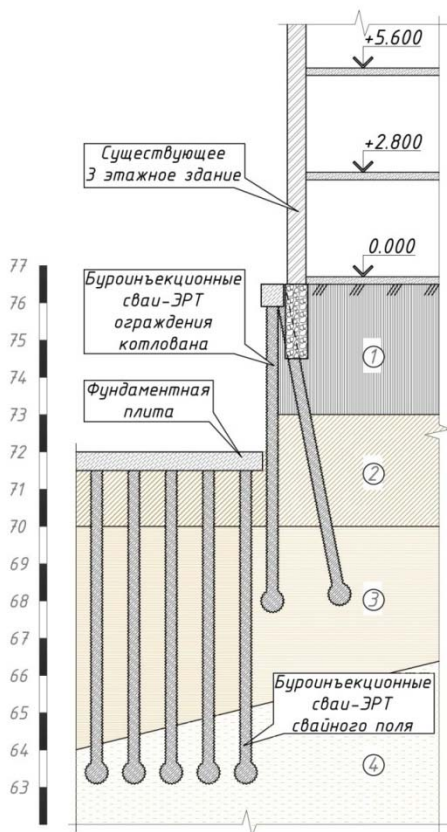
Схема усиления основания фундаментов существующего 3х этажного здания с помощью буроинъекционных свай ЭРТ (РИТ, ФОРСТ, ЭРСТ): 1 – насыпной грунт; 2 – песок пылеватый; 3 – песок мелкий; 4 – песок средней крупности
